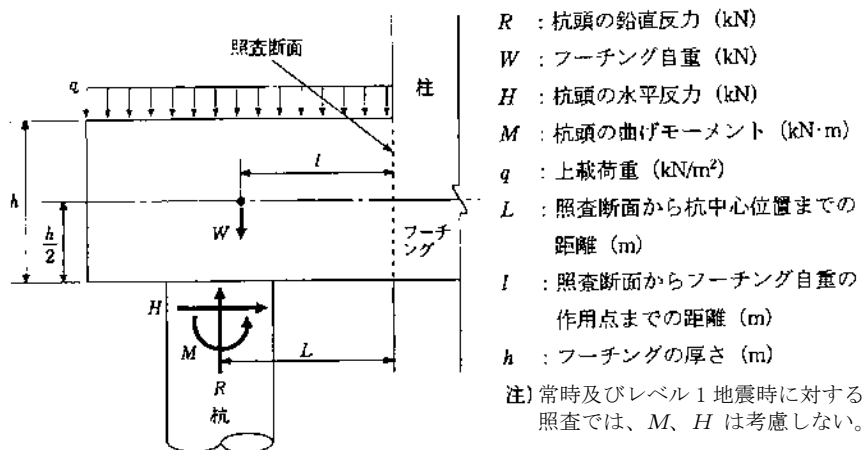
柱断面が照査断面の場合の作用位置 (杭基礎フーチングの場合)
